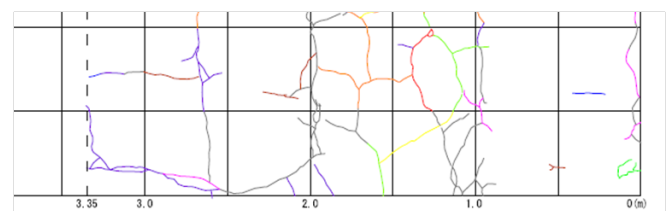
図-7 と同区間におけるスケッチ法によるひび割れ図
